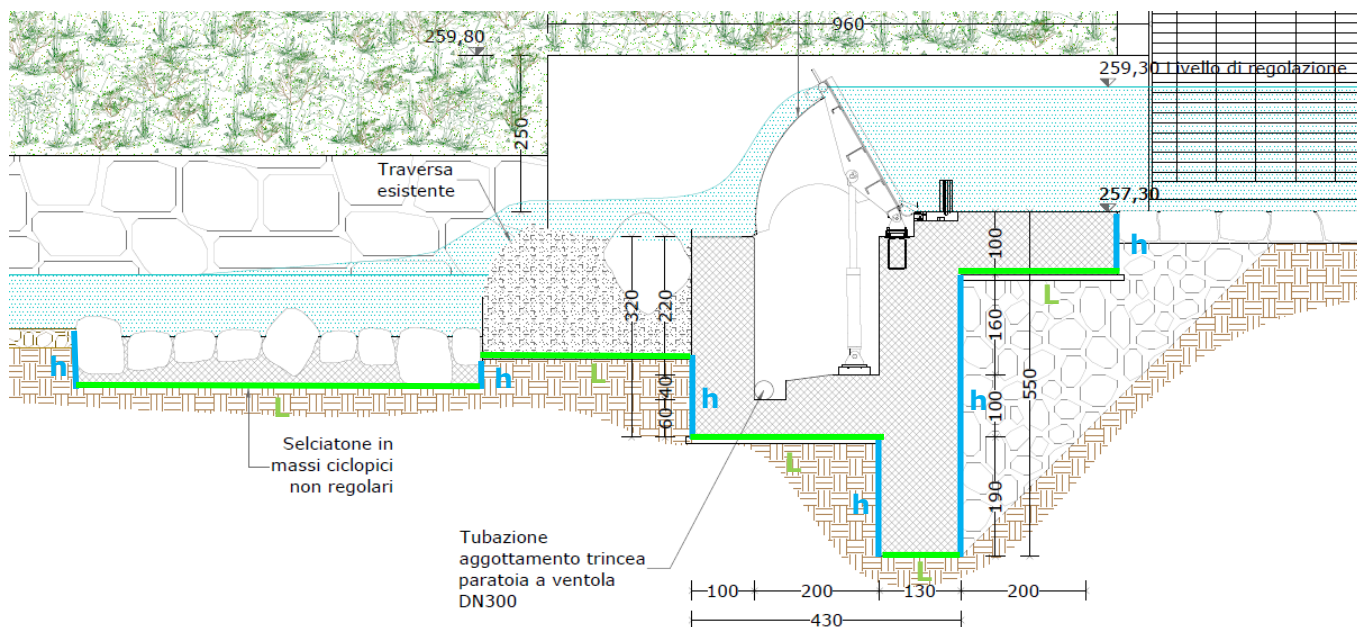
Sezione traversa con evidenziato dente di fondazione.
